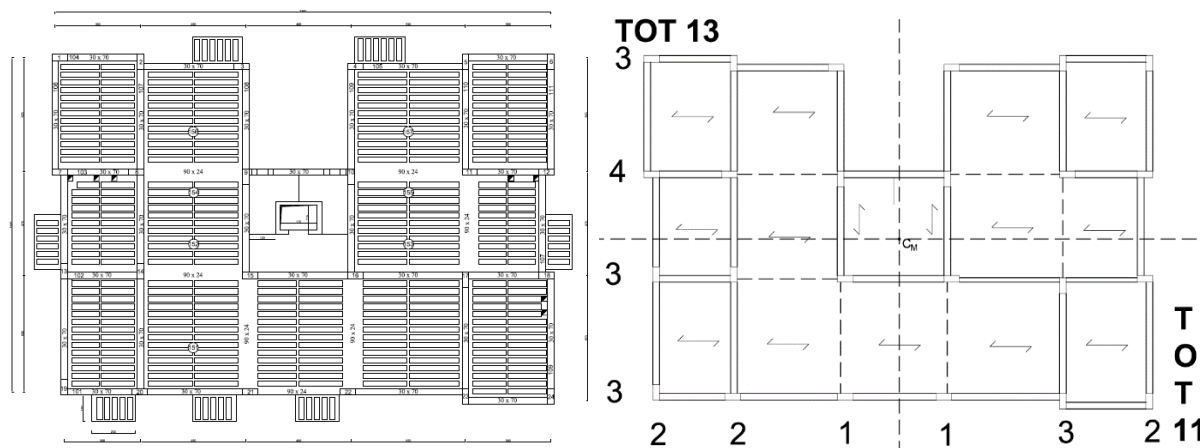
Distribuzione dei pilastri nella carpenteria tipo
